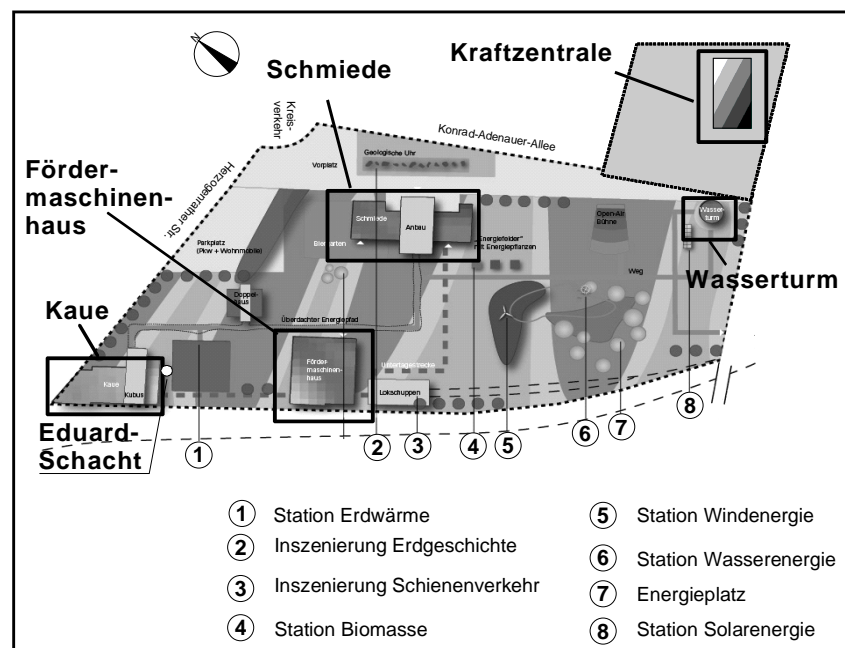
Übersichtslageplan ENERGETICON-Gelände
